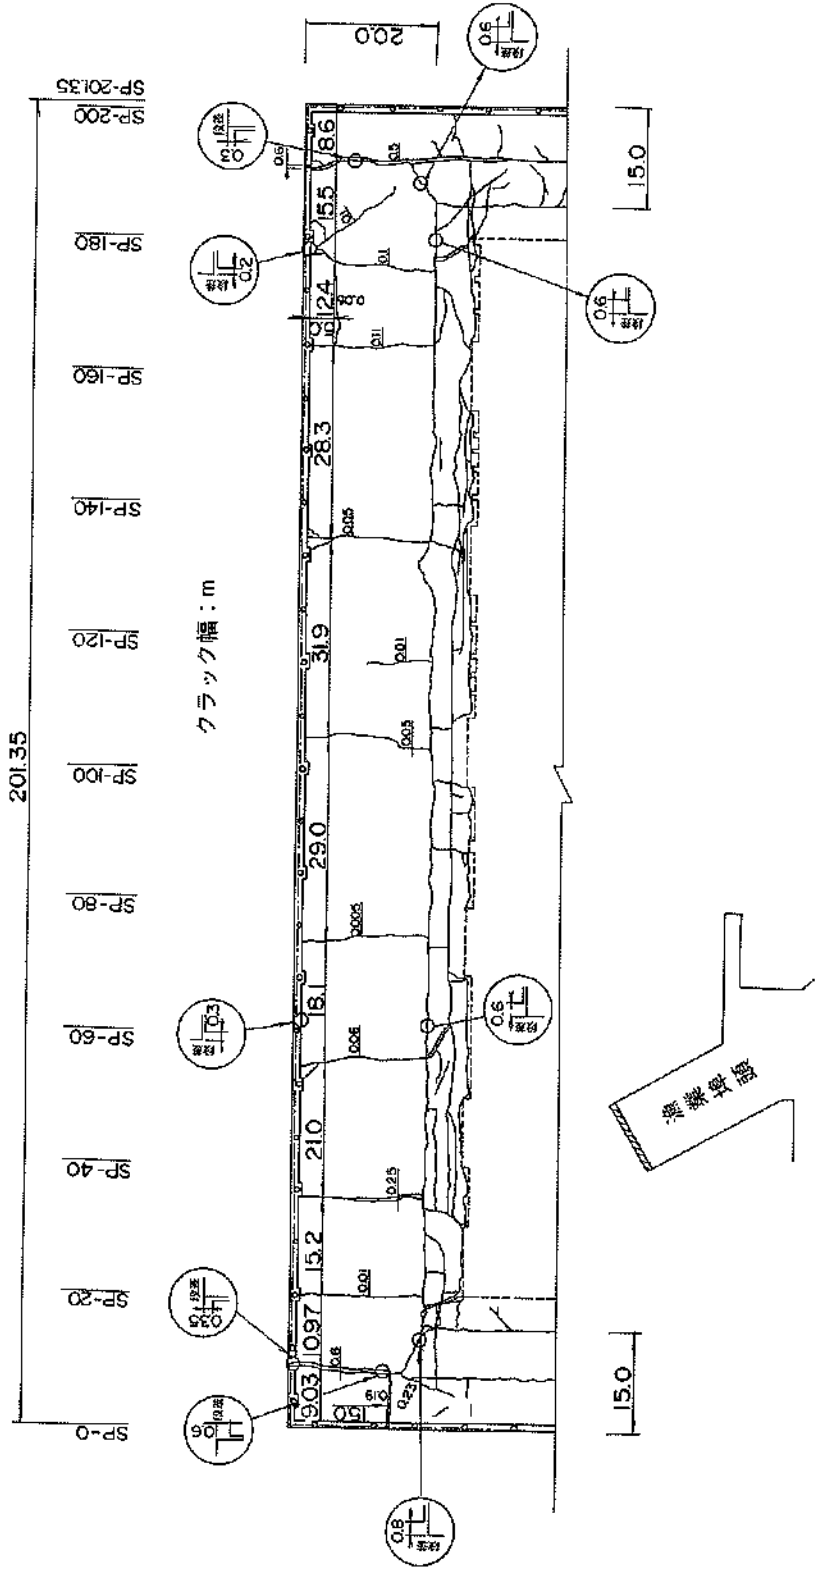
エプロンクラック平面図 (漁港埠頭, ②南側岸壁(-7.5m))
